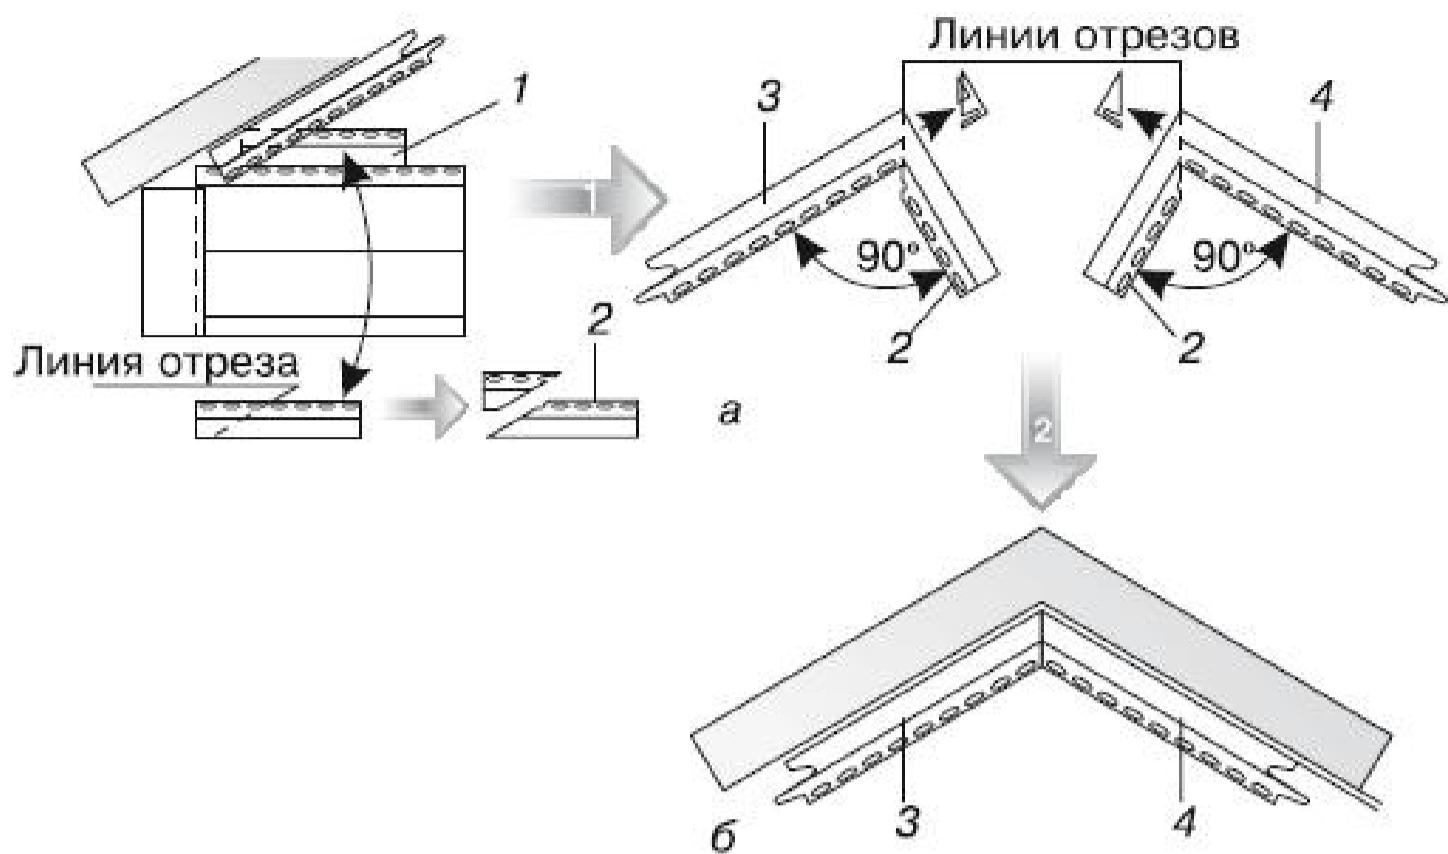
Установка J-профиля (крыша): а – вырезание шаблона и установка J-профиля; б –стыкование J-профиля по длине; 1 – обрезок J-профиля; 2 – шаблон; 3 – левый элемент обшивки; 4 – правый элемент обшивки
